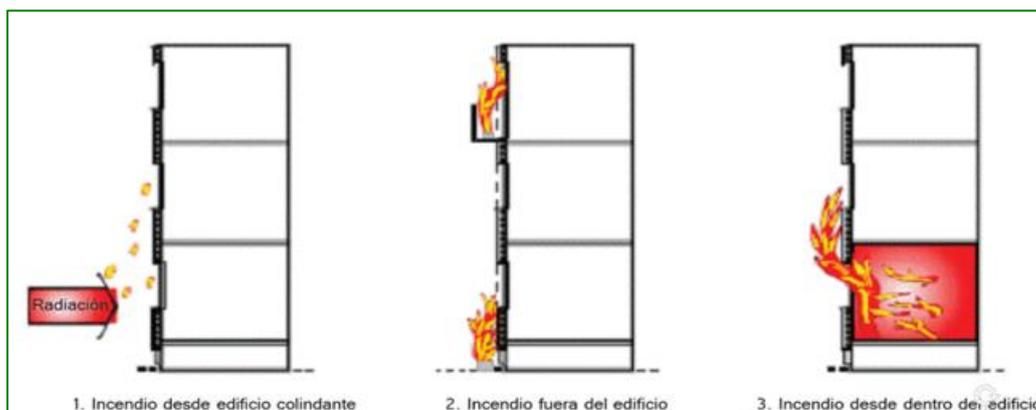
Mecanismo de propagación del fuego en fachadas. Fuente: Kotthoff y Riemesch.
